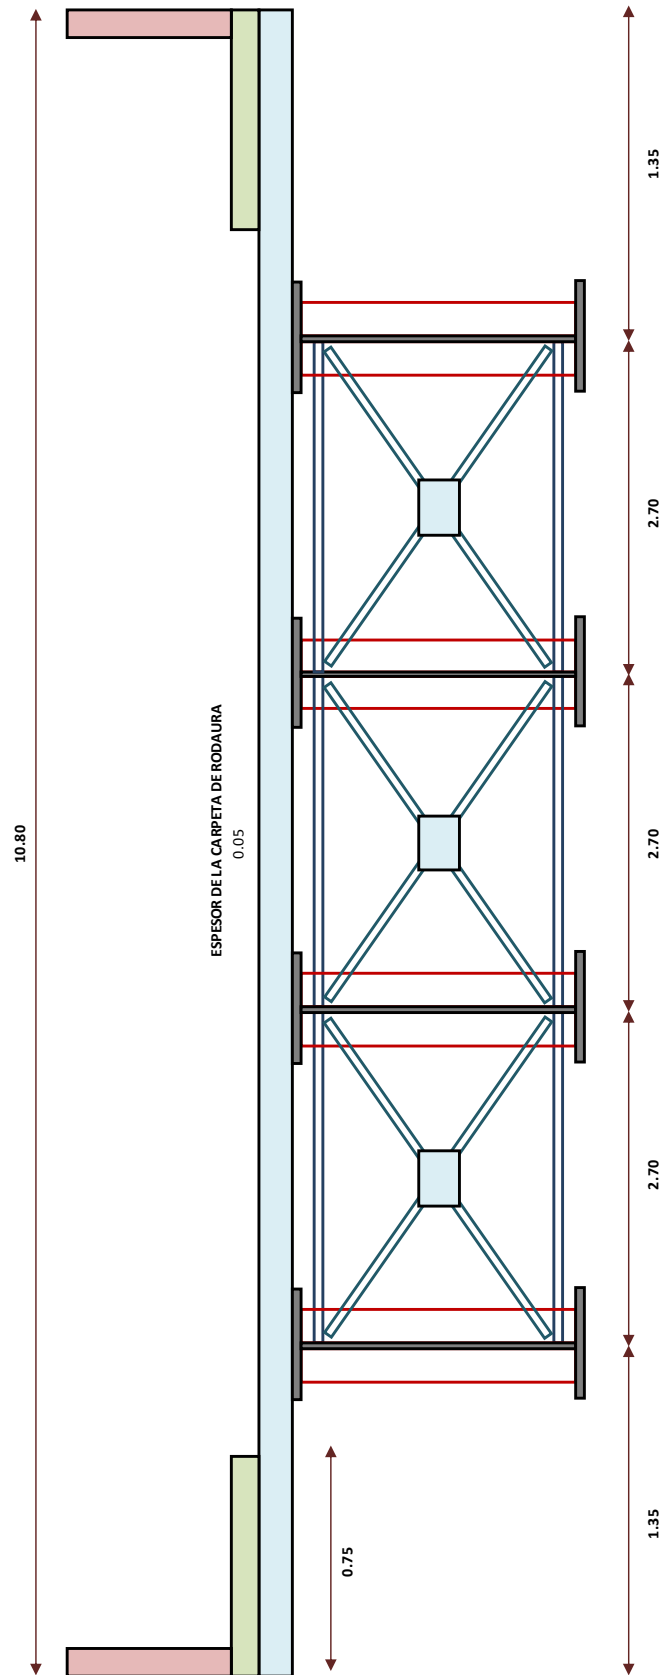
Sección transversal del puente Cebadas tramo en acero.
